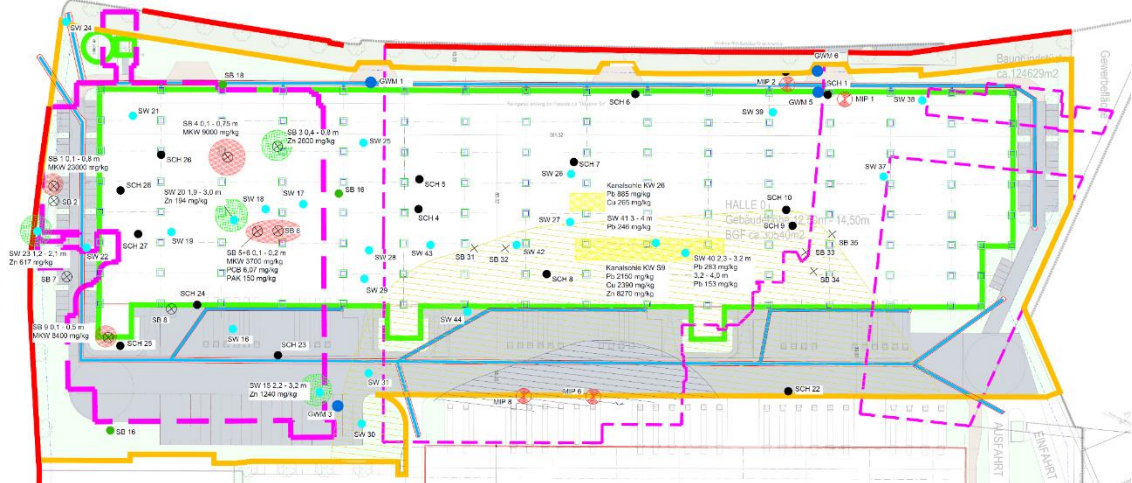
Bauabschnitt 1a, Neubau der Halle 01
